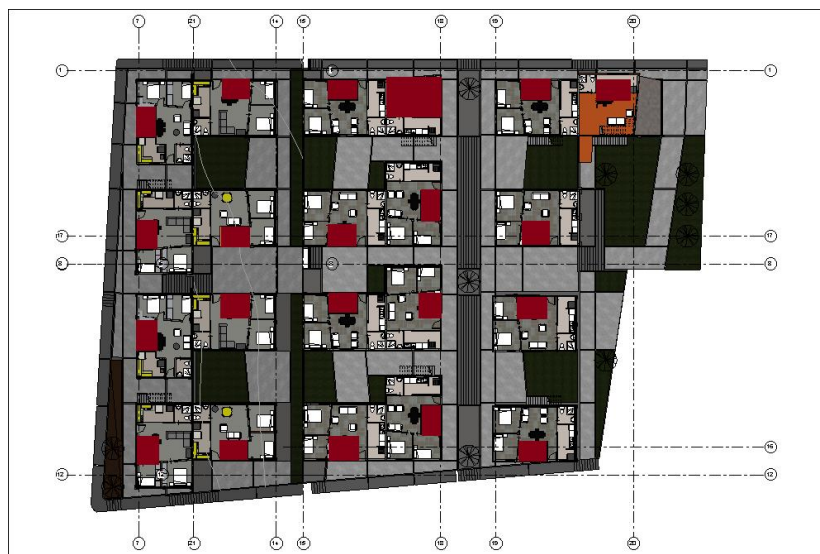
Planta arquitectónica. Locales comerciales. Fuente: Propia
